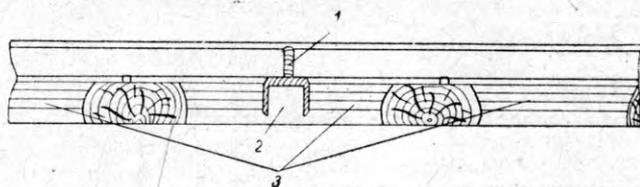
Схема приварки к подошвам рельсов кусков металла:
